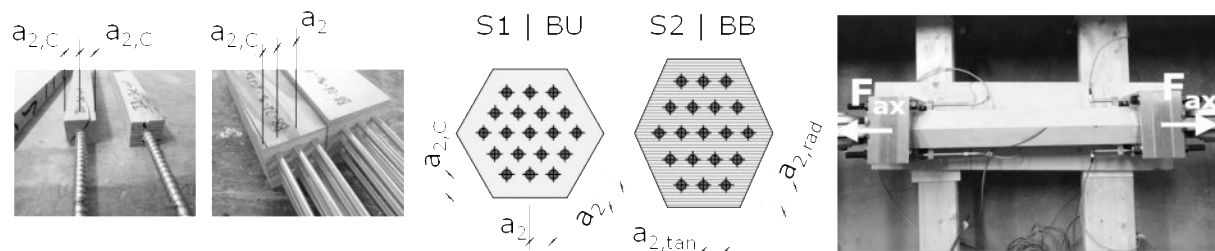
Einschraubprüfungen: Einzelschrauben und Schraubengruppen (links); Querschnitte und Abstände geprüfter Hirnholzanschlüsse (mittig); Prüfkörper mit beidseitigem Hirnholzanschluss im Prüfgerüst (rechts).
